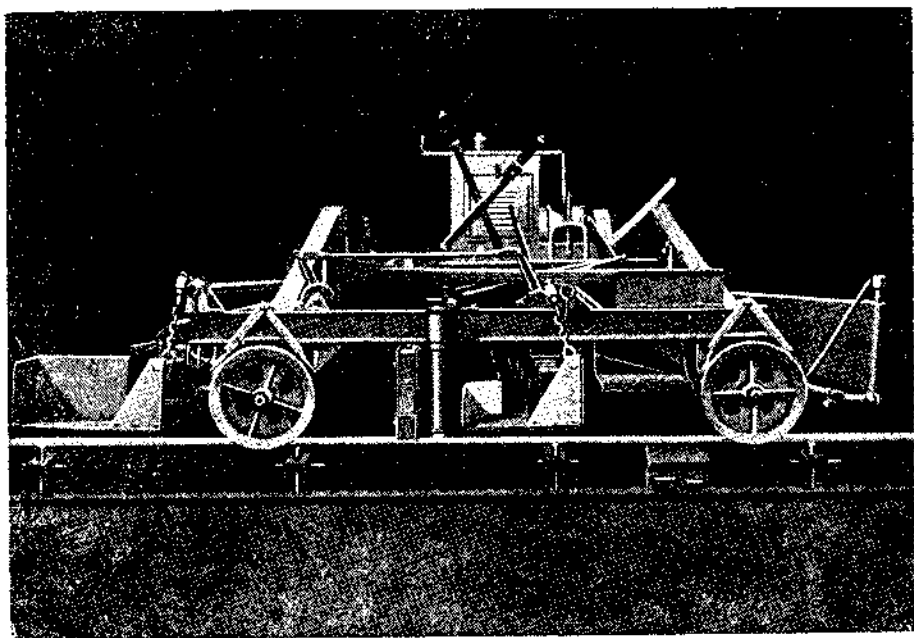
Боковой вид финишера Лейквуд (модель 1932 г.).
